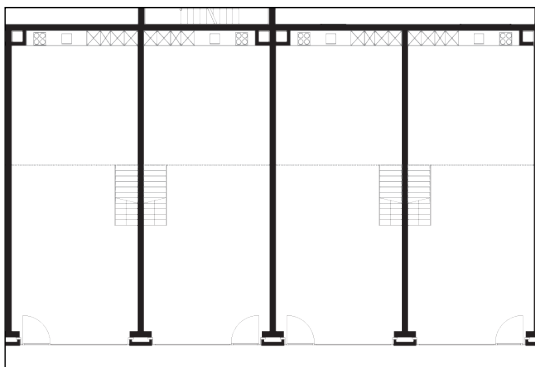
Grundriss Wohnateliers Sieb 10,
